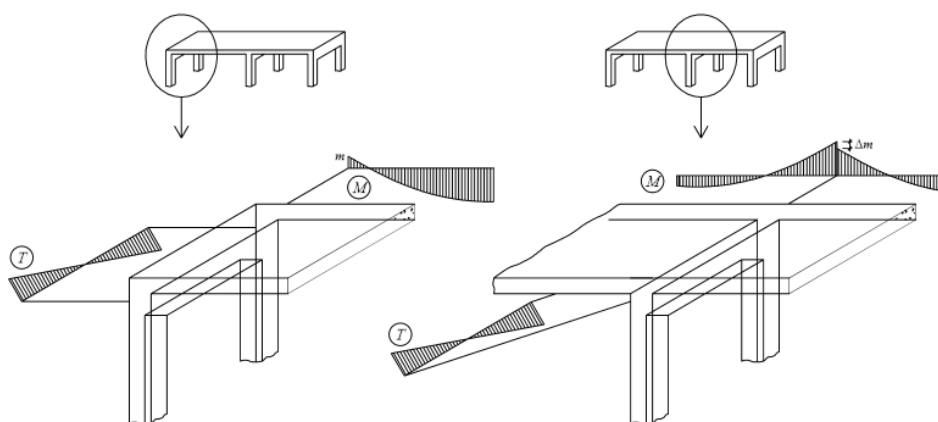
Laje de pavimento com apoios de extremidade e/ou de continuidade [10].
